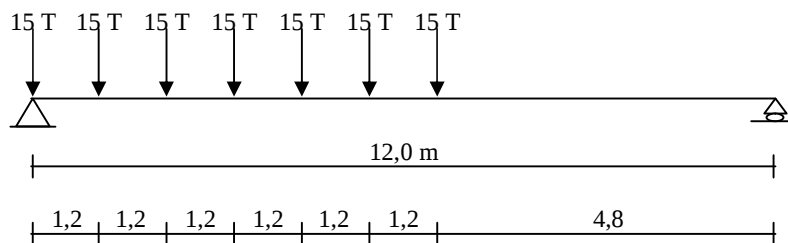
Desain Konstruksi Jembatan Darurat BH -22
